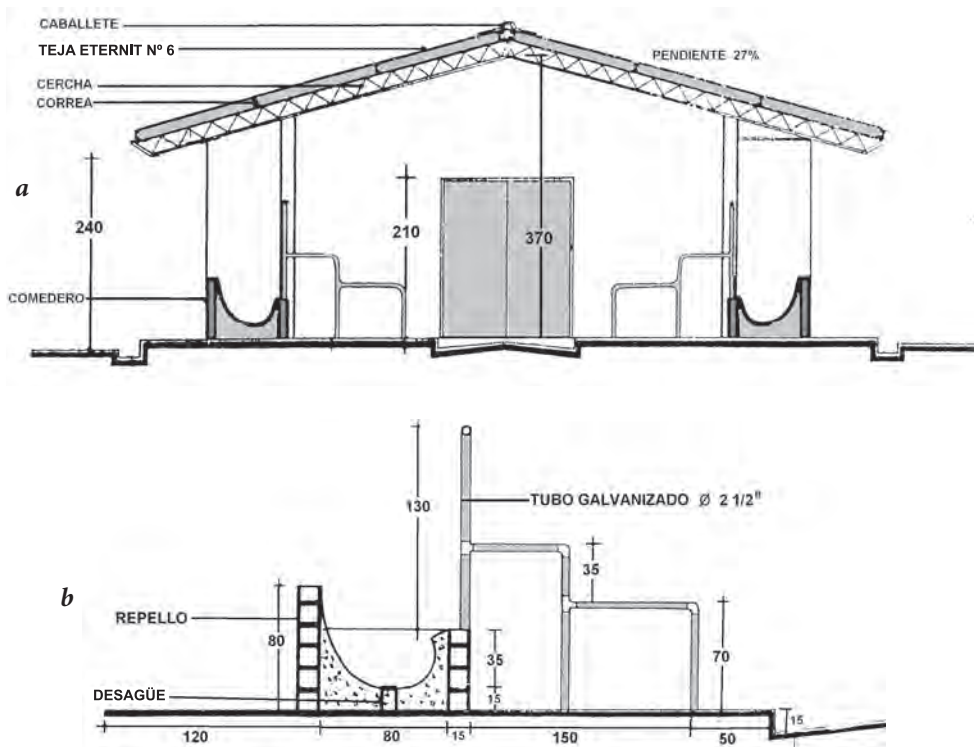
Especificaciones constructivas de la cubierta y las plazas en una nave de semi-estabulación para vacas lecheras.
